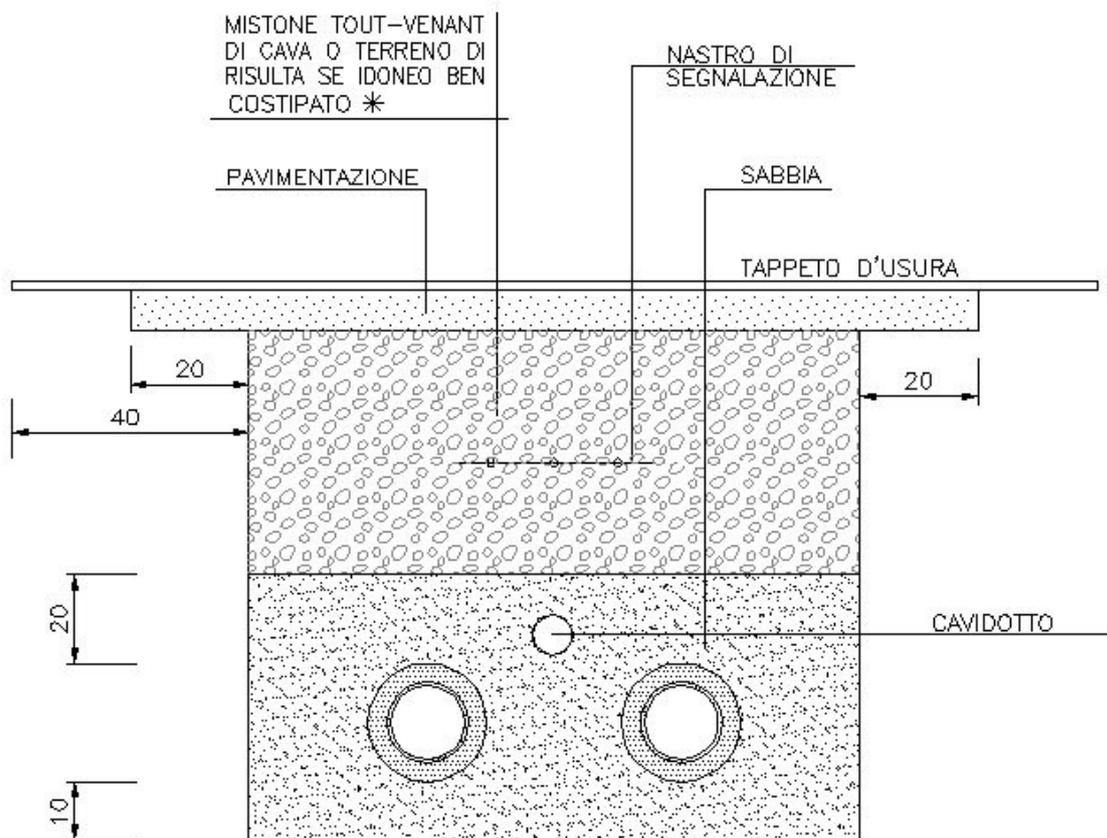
Rete Teleriscaldamento, sezioni tipo
